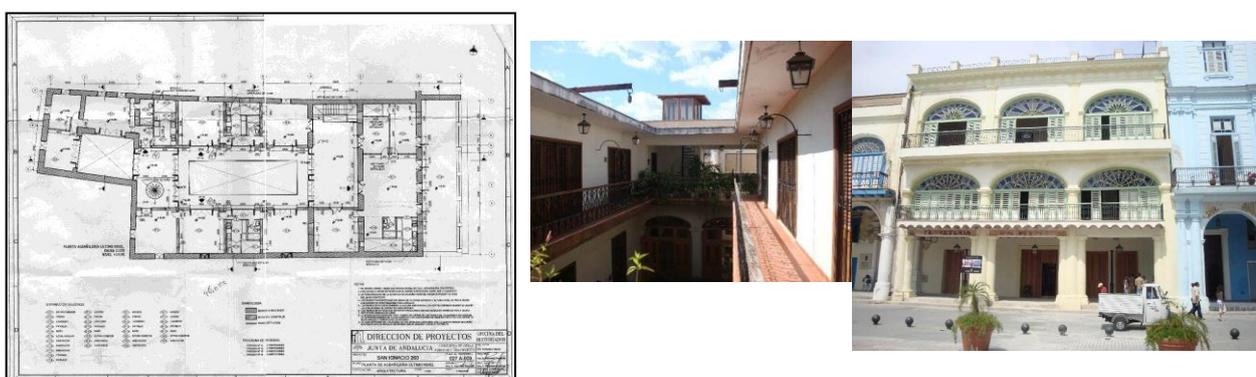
San Ignacio 360, frente a la Plaza Vieja. Antigua casa señorial devenida en ciudadela y ahora rehabilitada como edificio de apartamentos. Plano de planta, fachada principal y vista del patio interior: la disposición interior ha generado viviendas con amplias áreas y espacios comunes sobredimensionados. Fuente: Dirección de Proyectos de Arquitectura y Urbanismo. OHCH, Fotos: Raimundo de la Cruz, 2014.
